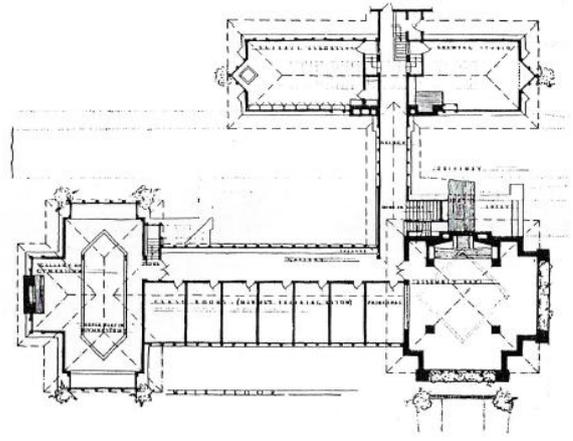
PLANTA HILLSIDE HOME SCHOOL
